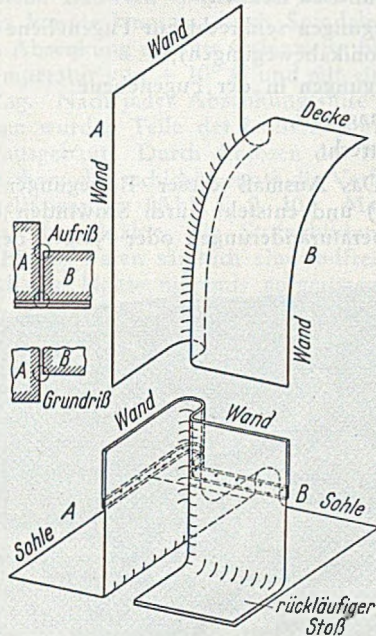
Eckformstücke für Anschluß kleinerer an größere Bauwerksteile.
